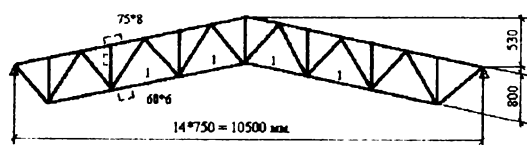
Схема расчётных стержней фермы, 1 – расчётные стержни фермы
